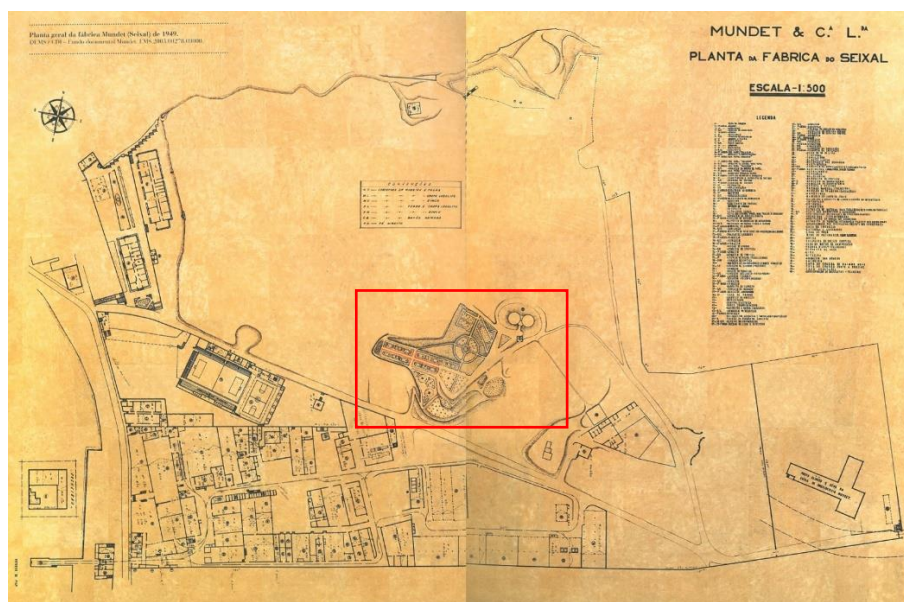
Planta Geral da fábrica Mundet (Seixal) de 1949. Fonte: (Filipe et al. 2010)
